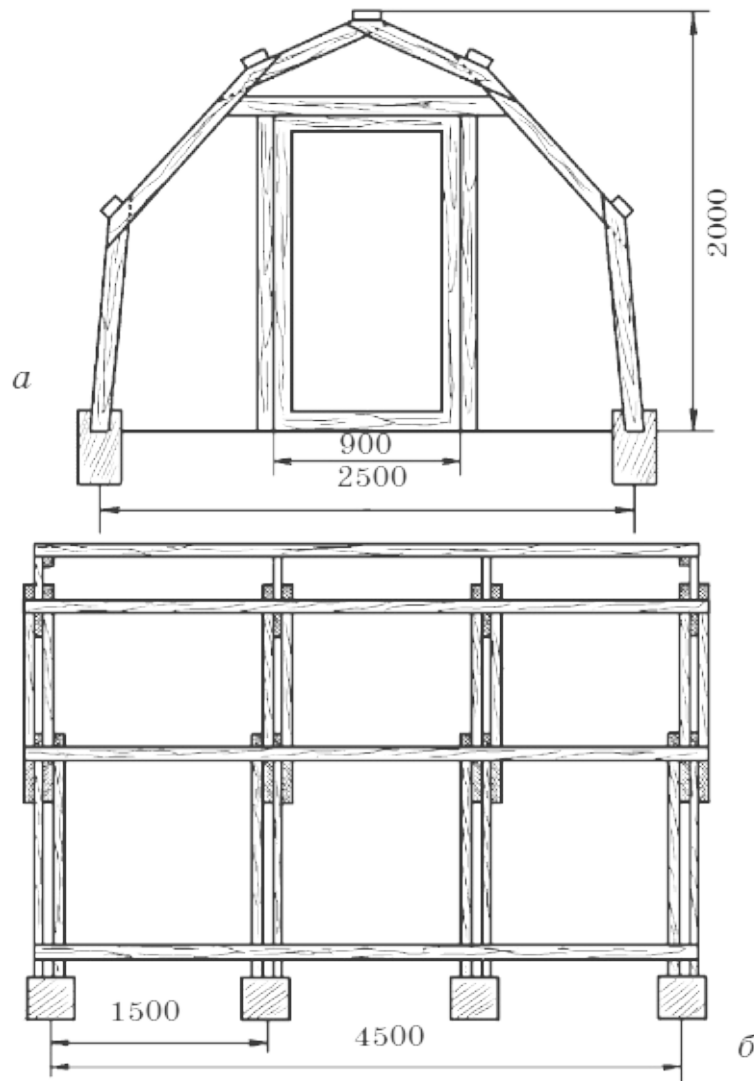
Арочная теплица: а — в разрезе; б — вид сбоку
